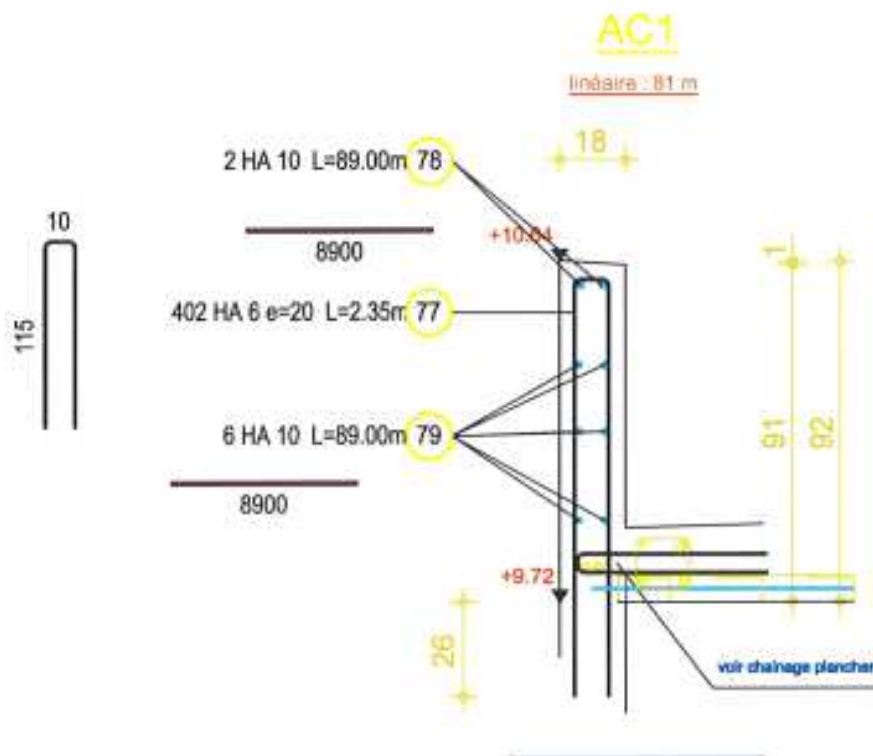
Ferrailage des acrotères en béton armé situés niveau R+2 (vue en coupe)
